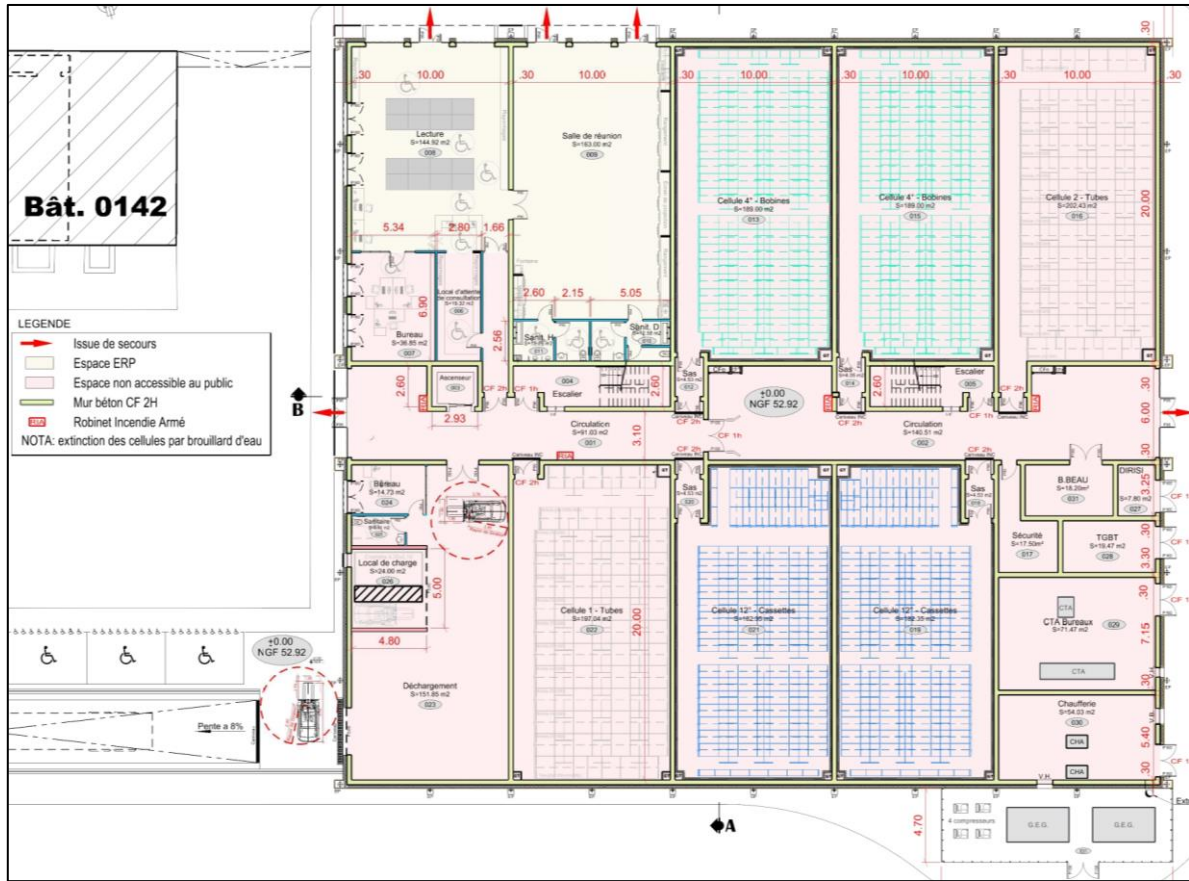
Plan de masse du rez-de-chaussée du bâtiment projeté (source : ESID BORDEAUX)
